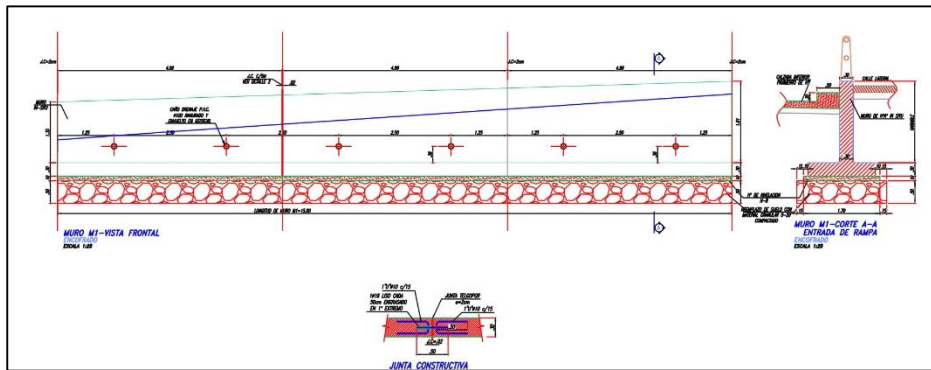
Perfil longitudinal y sección transversal de los distintos tipos de muros. (PLANO N° 25)
